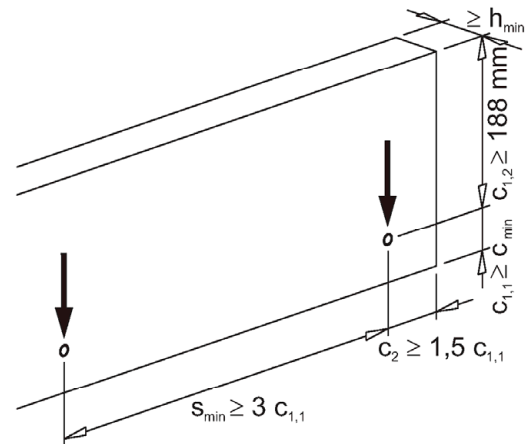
Einbausituation Wandfläche - Querbeanspruchung mit Betonkantenbruch, ohne Rückhängebewehrung
